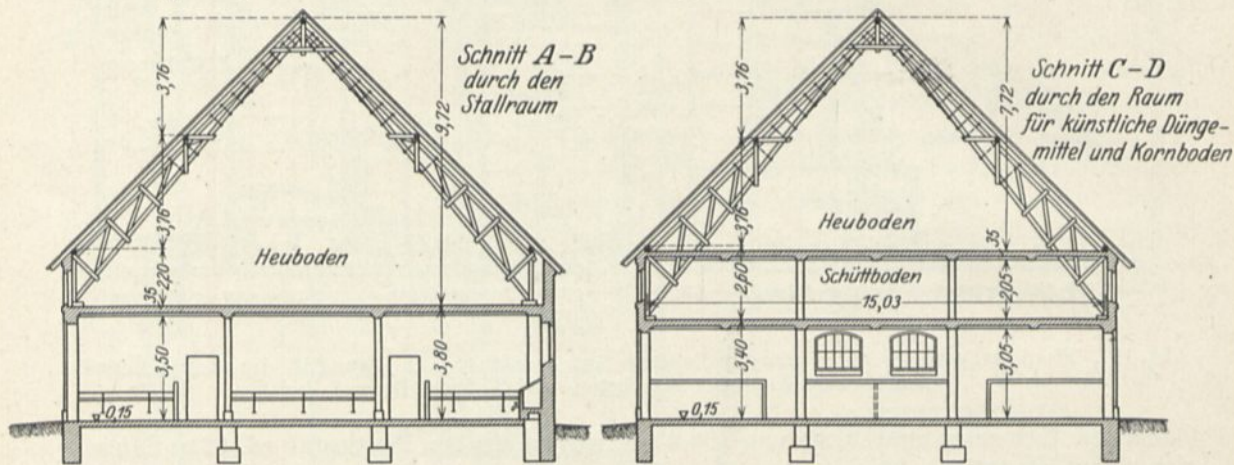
Pferdestallgebäude Baudach. Querschnitte. (Vgl. Abb. 137 u. 139.)
